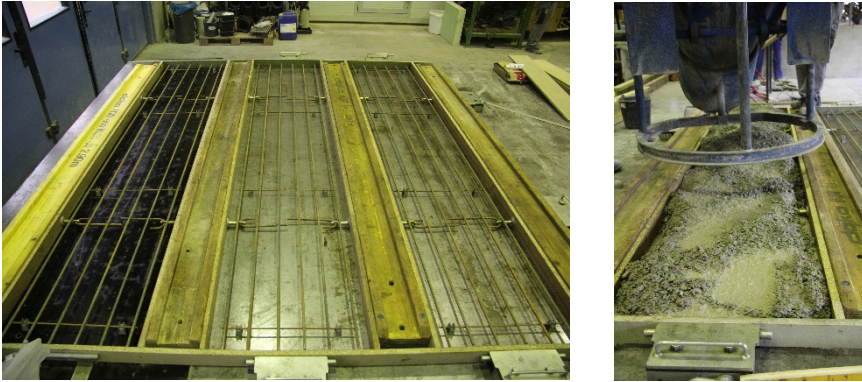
Vorbereitete Schalung mit eingelegter Längsbewehrung (links), Einbringen des Betons in die Schalung (rechts)
